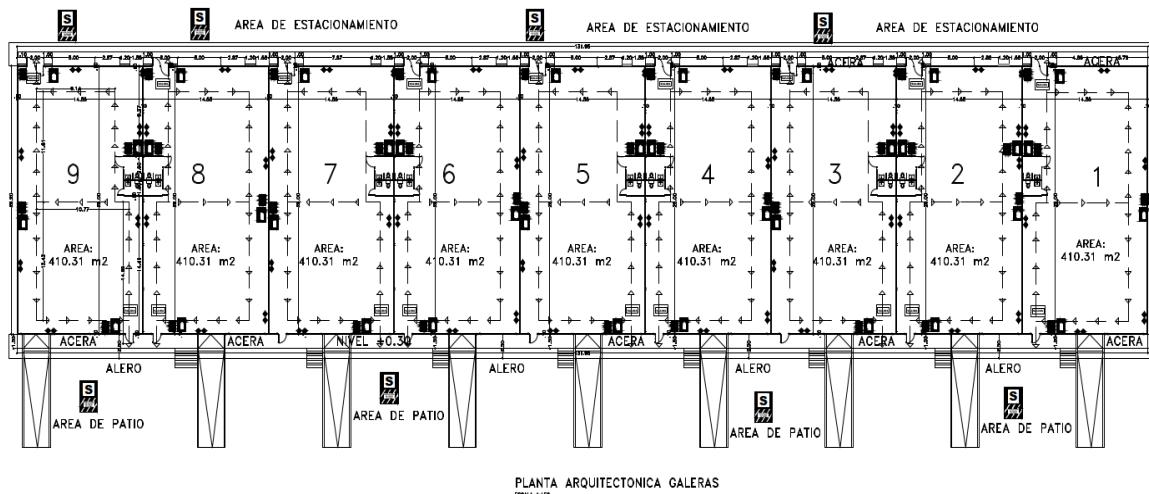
Planta arquitectónica Galeras. Fuente: Plano del proyecto
